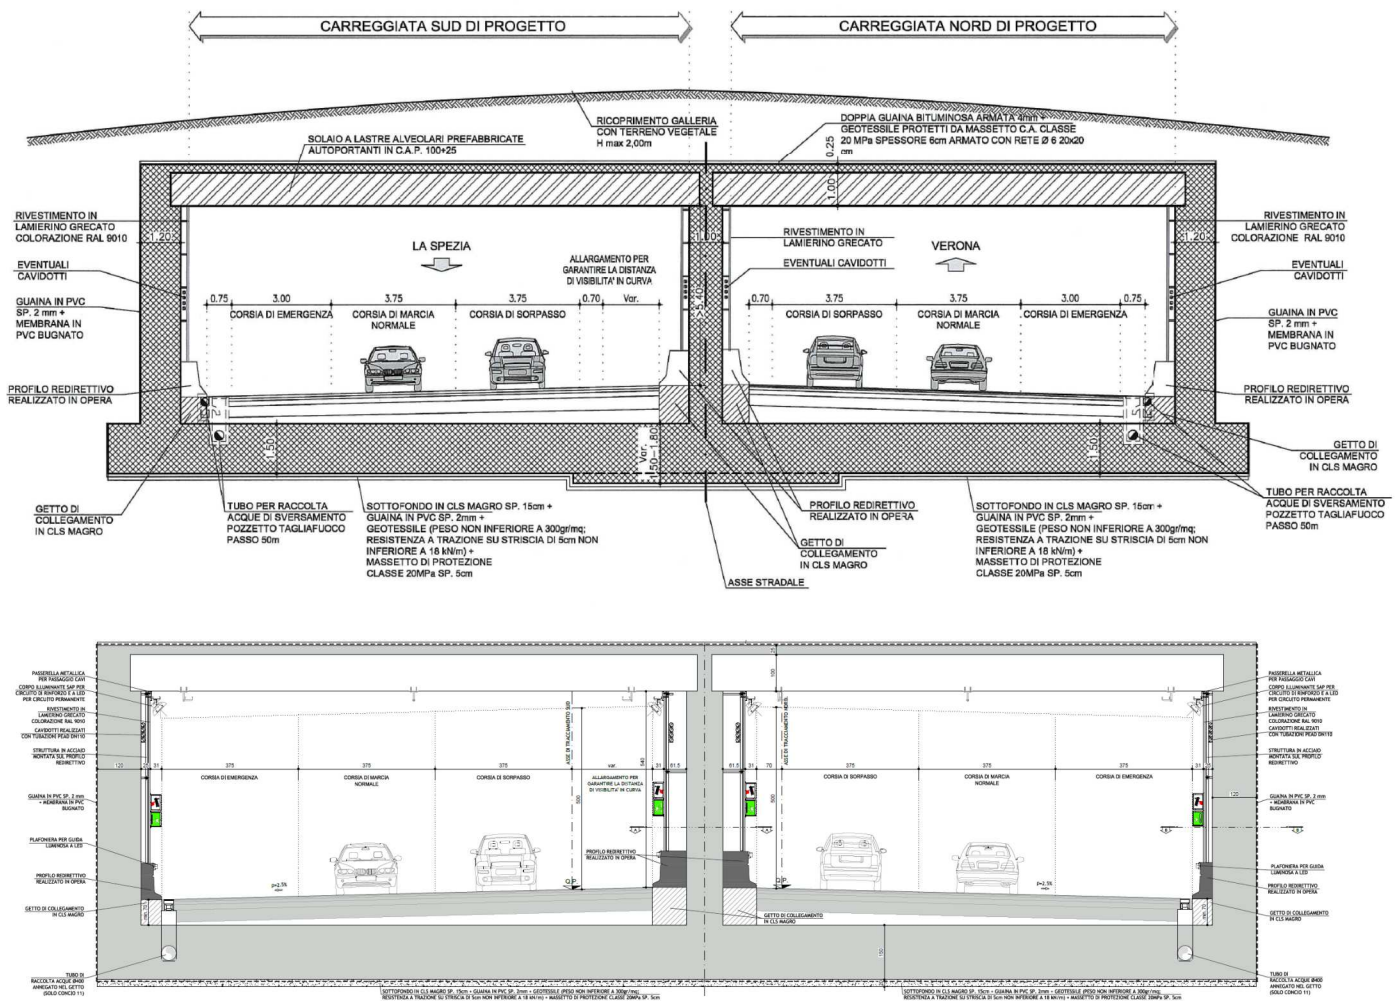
Sezioni tipologiche tratto di galleria realizzato con conci scatolari: confronto Progetto Definitivo (sopra) – Progetto Esecutivo (sotto).
